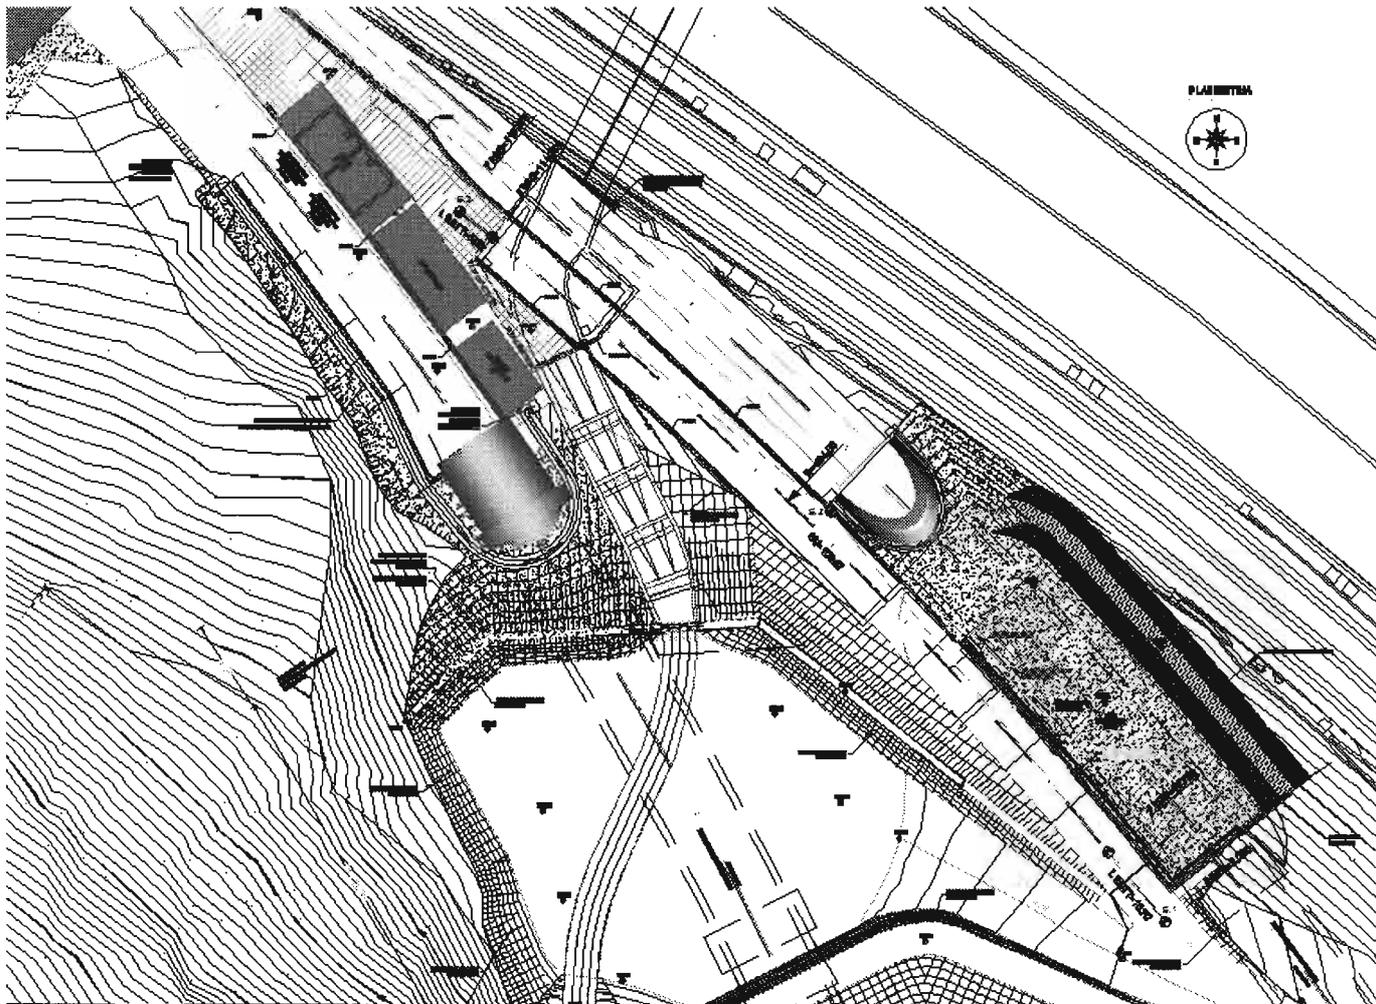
Schema planimetrico Cantierizzazione Gardena Nord Fase Definitiva
